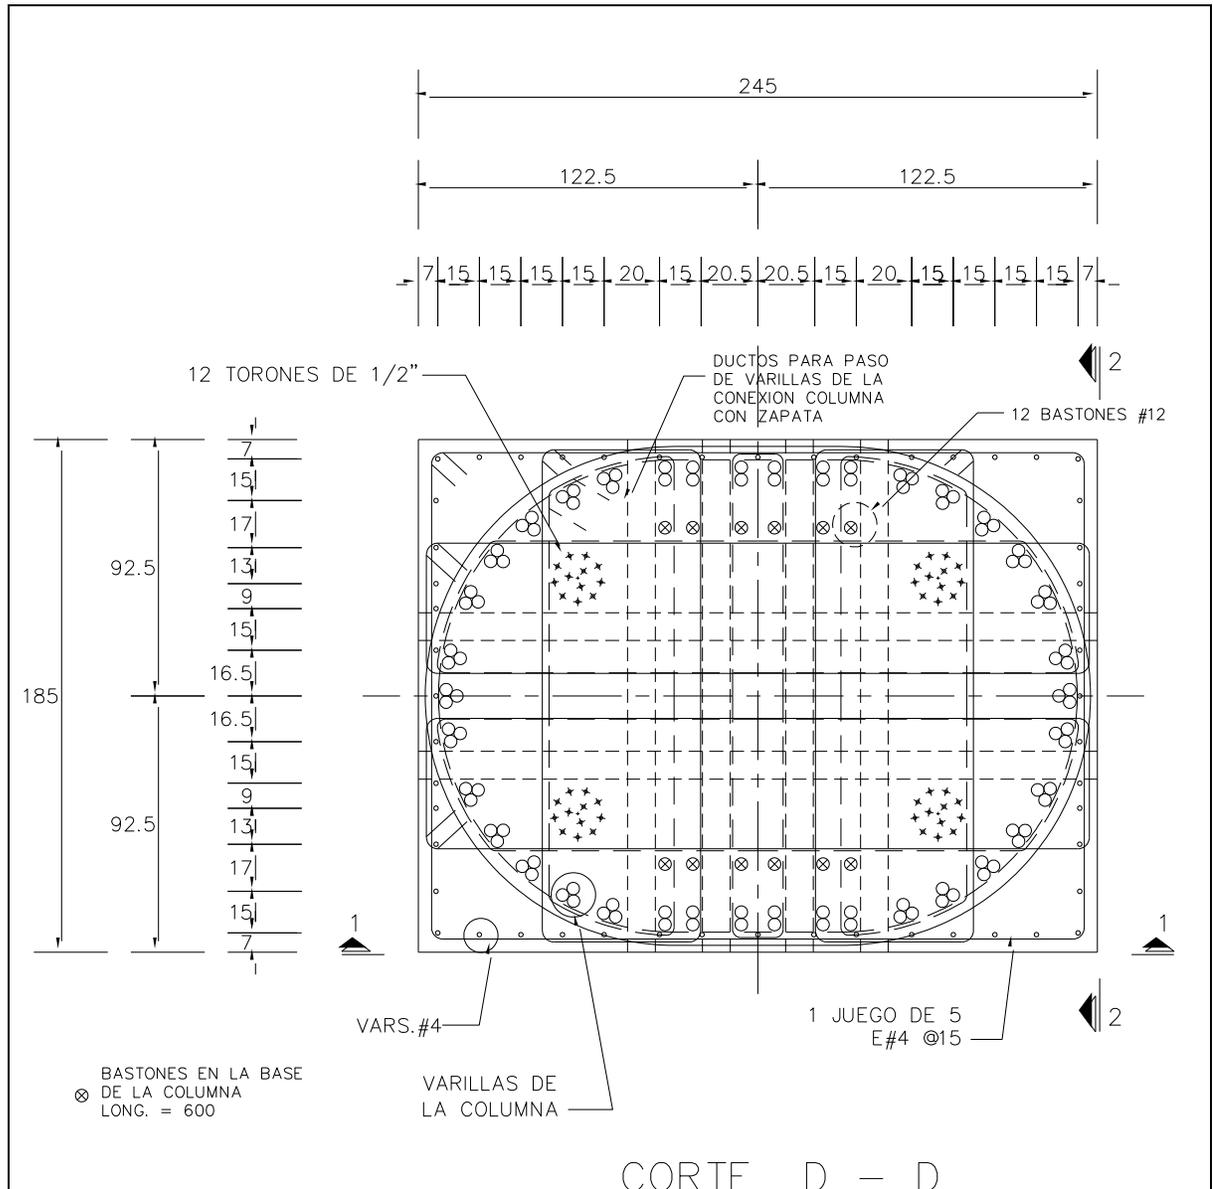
Refuerzo de columnas A-10 y A-11. Acotaciones en cm
